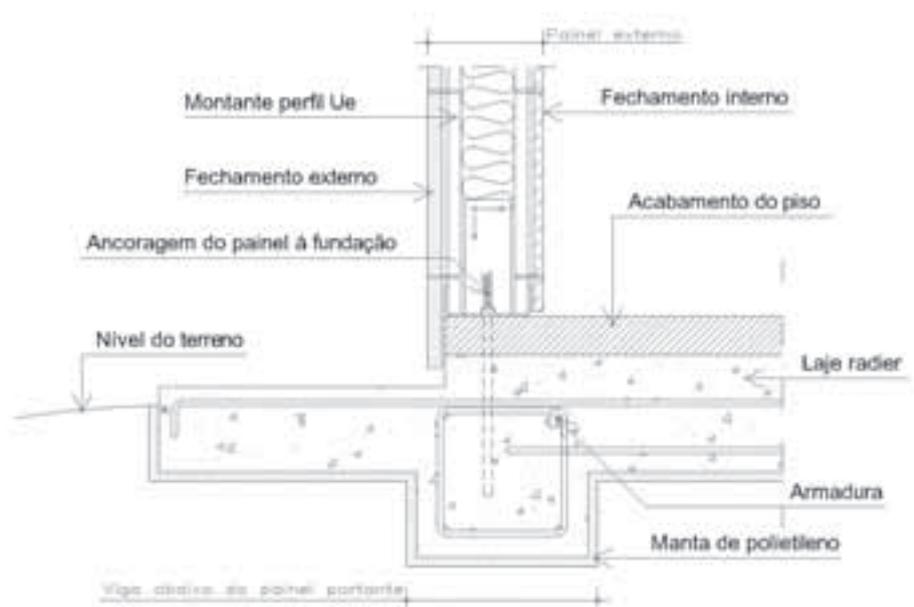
Detalhe esquemático de ancoragem de painel estrutural a uma laje radier (adaptado de Consul Steel, 2002)
